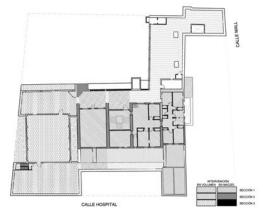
Plano de la planta bajo cubierta, con indicación de las diferentes intervenciones (Jordi Salvat)
